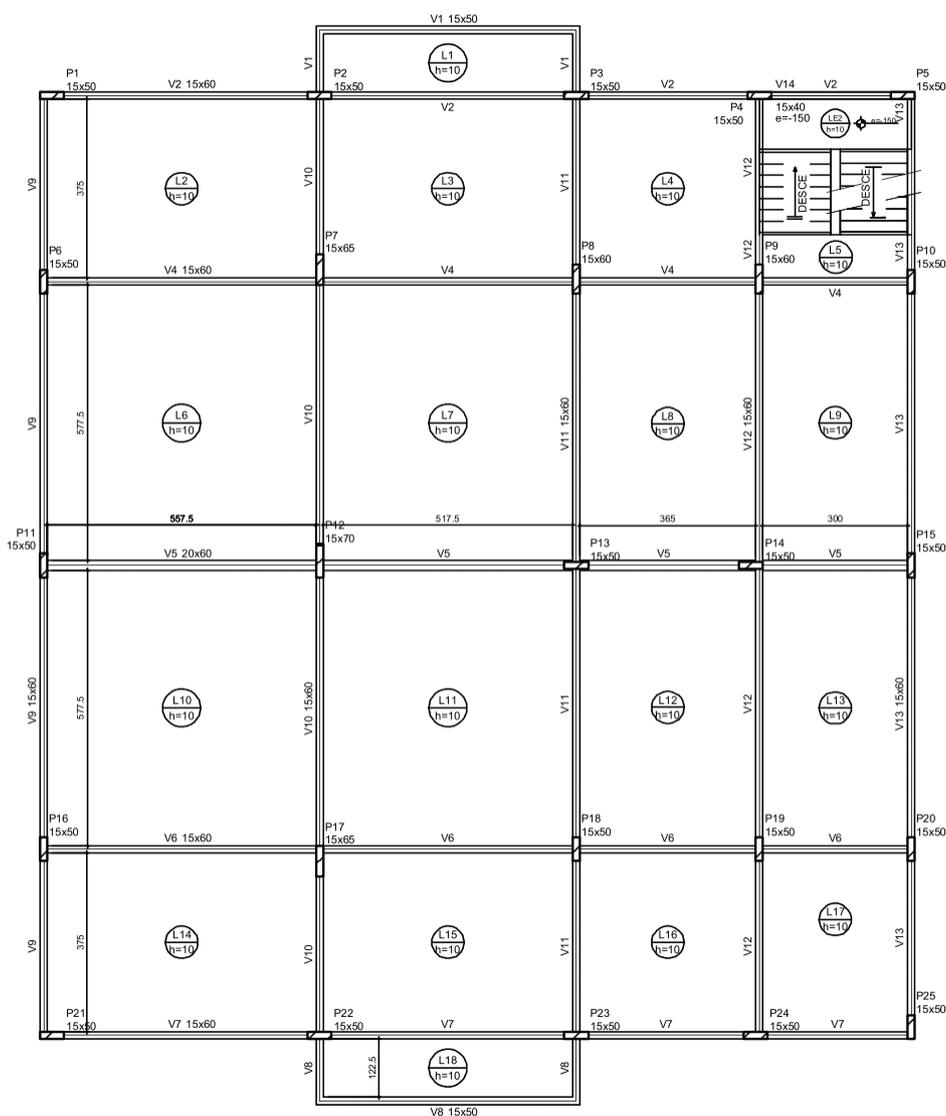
Planta de formas projeto estrutural em concreto armado.
